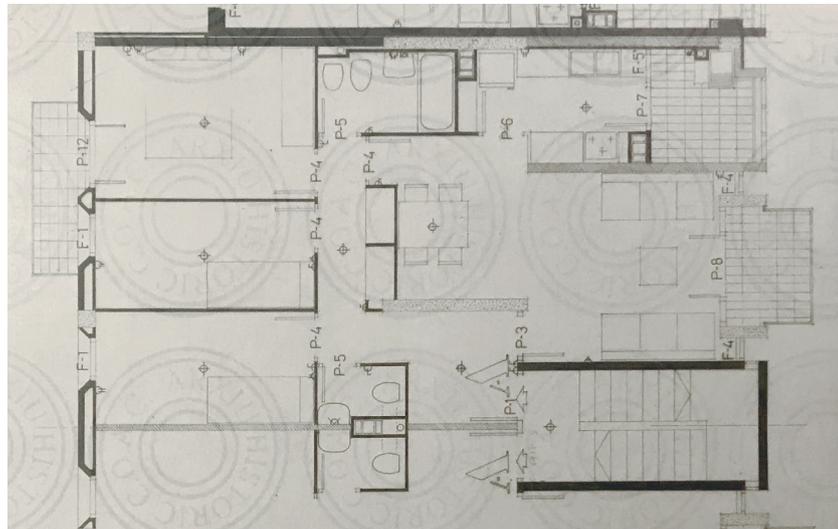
Planta vivienda-unidad en Monzón (1962) de Lluís Nadal
